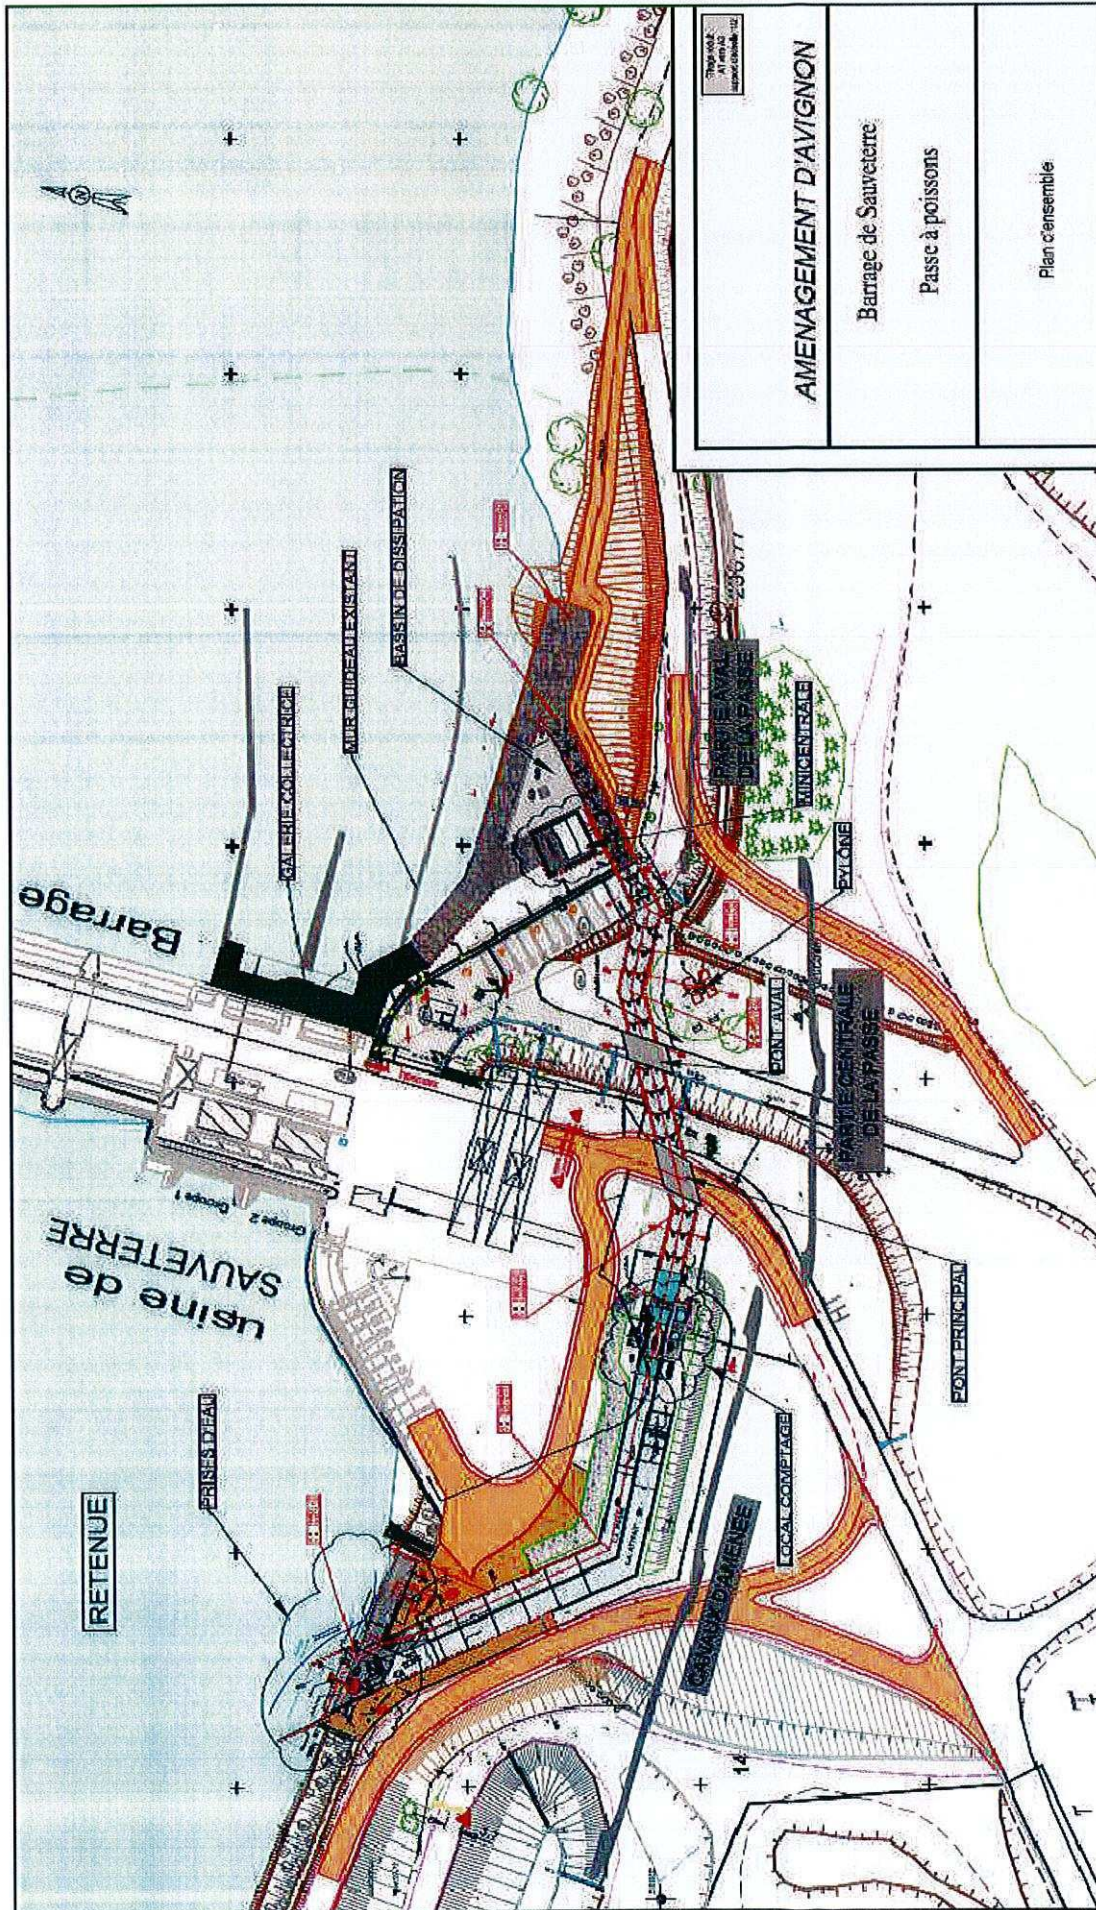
Plan d'ensemble du projet de passe à poissons sur le barrage-usine de Sauveterre – CNR, 2013.
